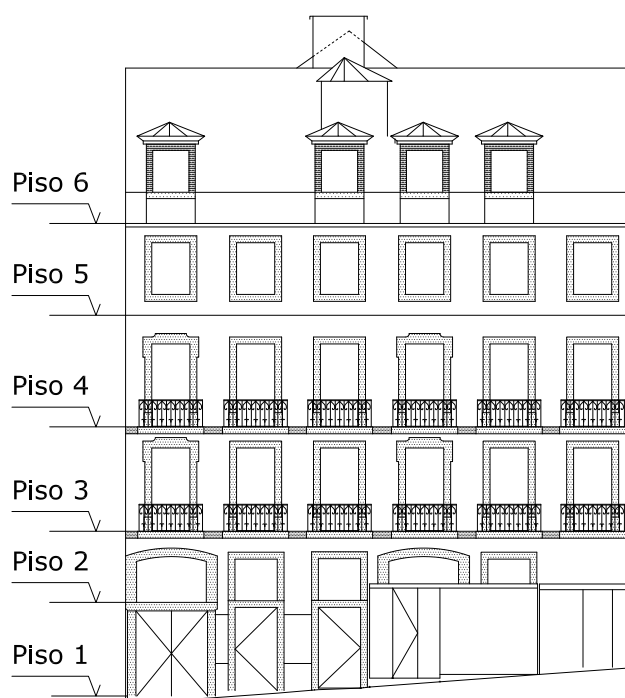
Fachada do Edifício em estudo situada na Rua da Misericórdia.
